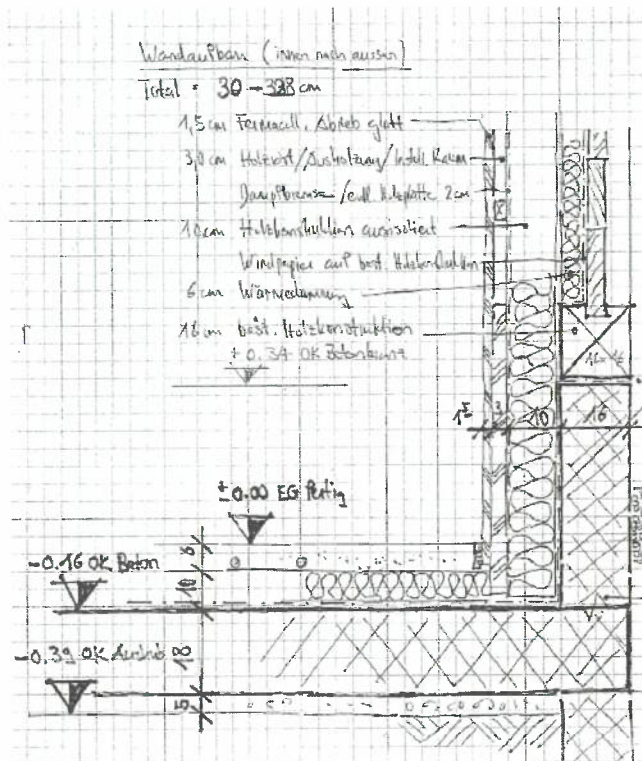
Detailskizze Wand- und Bodenaufbau im Erdgeschoss Mst. 1:10 (C. Wiedmer)
